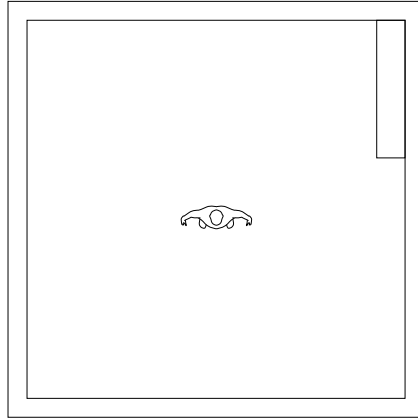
Pos. IV.III* | *Grundriss – M.1:100
